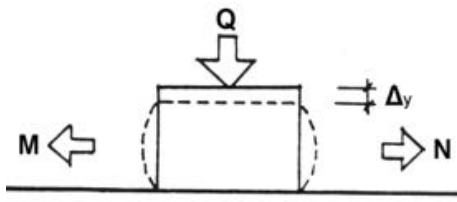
CEDIMIENTO EN ESTRUCTURAS METALICAS
